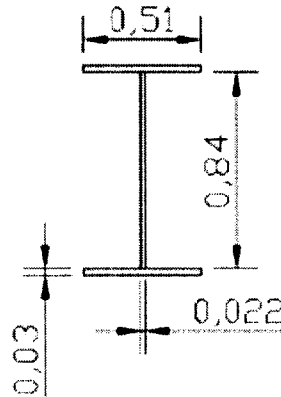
Pont bi-poutres - Dimensions d'une poutre (section A)
